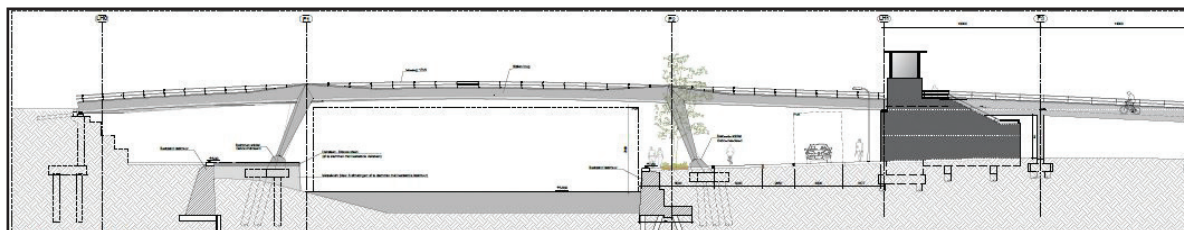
Plan van de fietsbrug tussen het Jagerspad en de Pierre Corneliskaai (bron: Stad Aalst).
